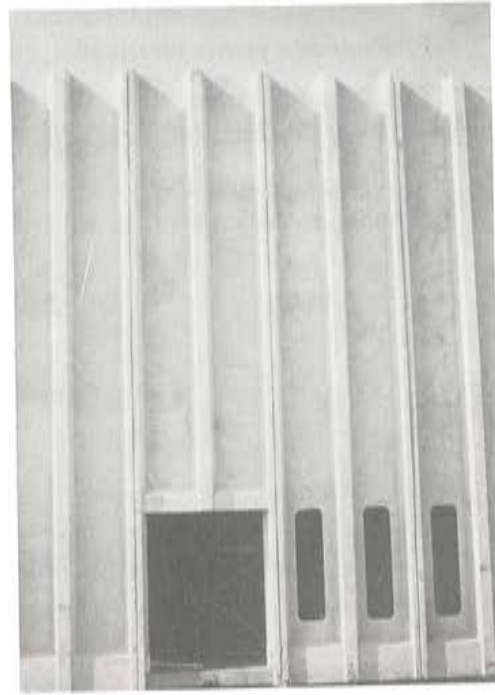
Detalle de huecos en fachada, puerta y ventanas.
